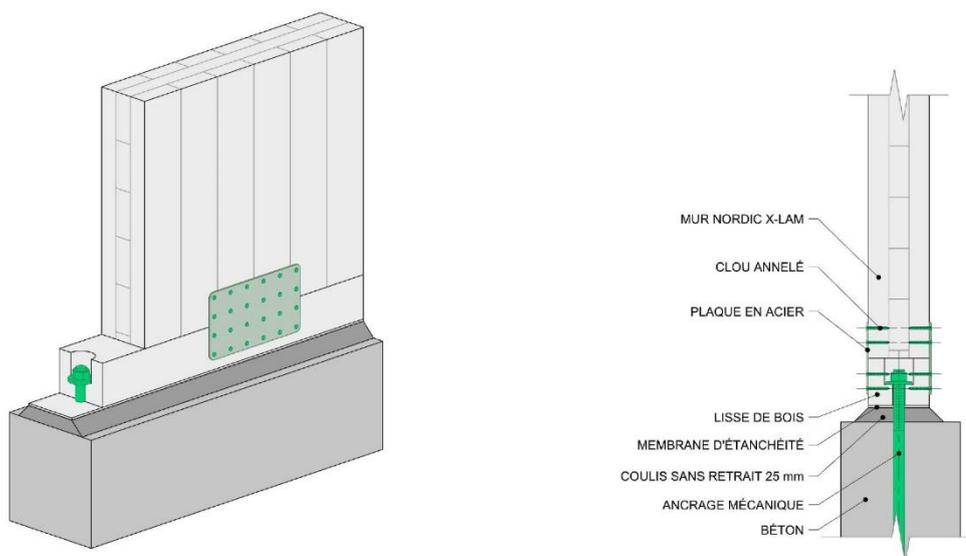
Mur sur lisse d'assise, plaque d'acier
